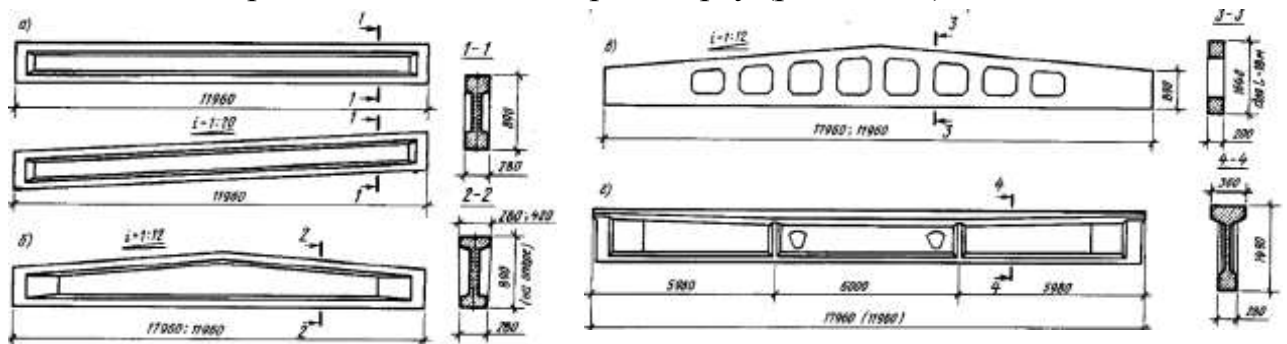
Залізобетонні балки покриття: а, г – односкілі і плоскі двотаврового перерізу; б – теж для багатоскілих покриттів;
